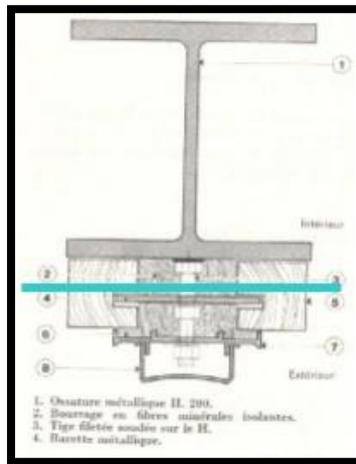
fixation d'un mur rideau sur poteau<sup>226</sup>
